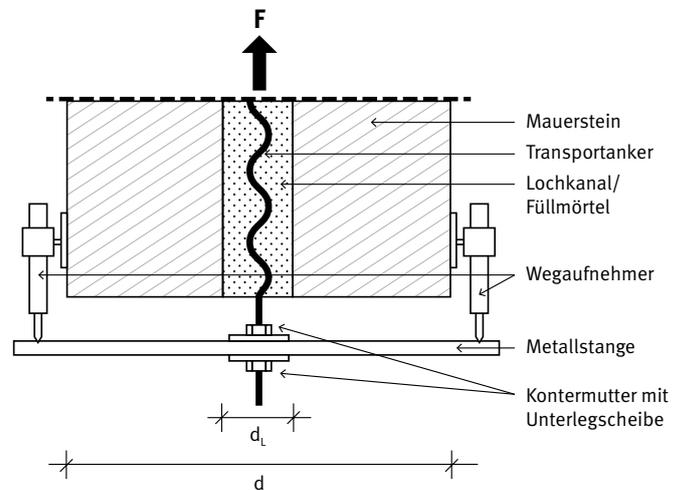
für Anordnung der Wegaufnehmer, Querschnitt
